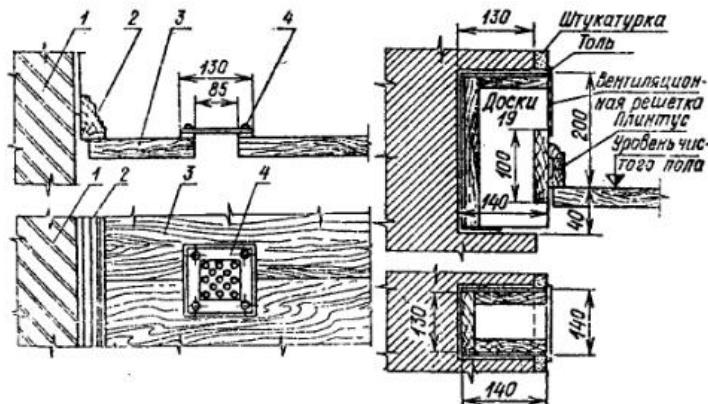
Вентиляционная решетка в полу (в мм): 1 — стена; 2 — плинтус; 3 — настил пола; 4 — вентиляционная решетка.
